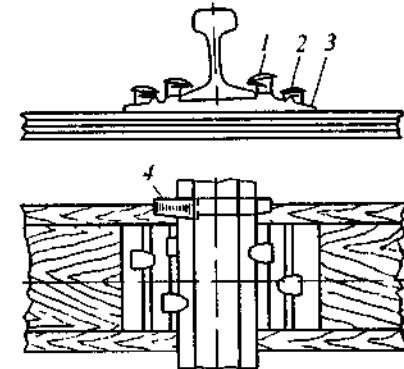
Промежуточное смешанное скрепление для деревянных шпал: 1 — прокладка; 2 — костьль обшивочный; 3 — костьль основной; 4 — противоугон пружинный
